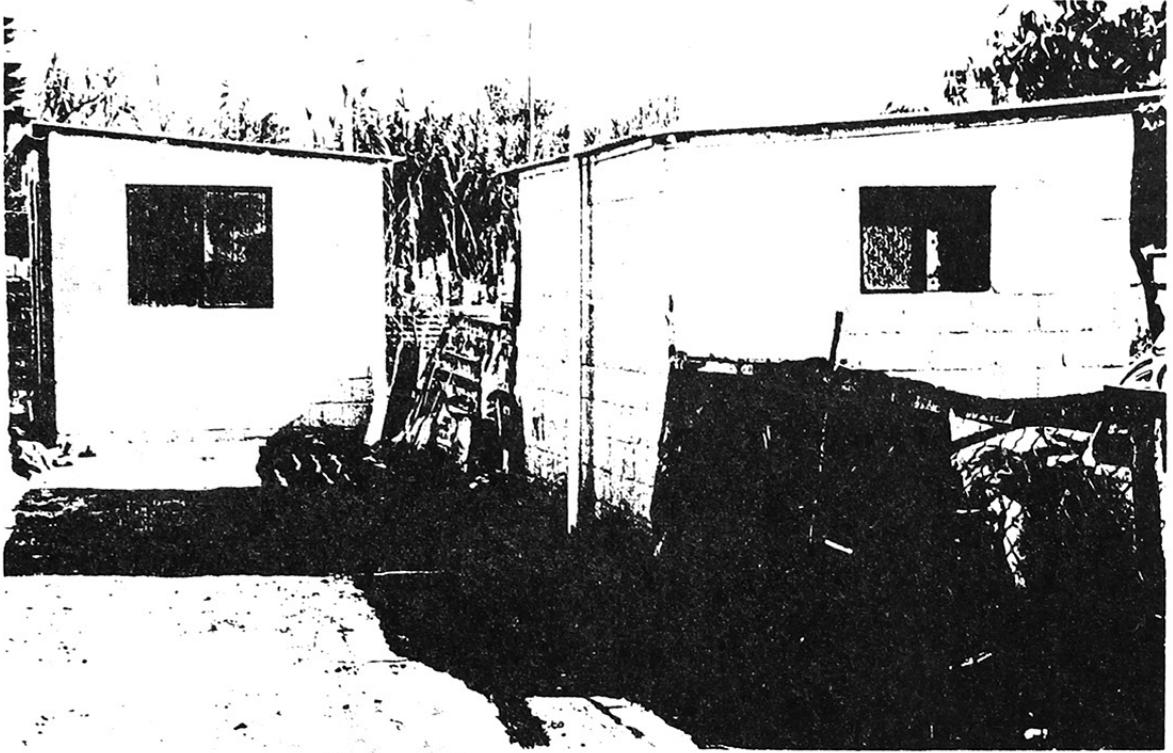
CASETA EN SISTEMA CONSTRUCTIVO EN BLOQUE DE CEMENTO
